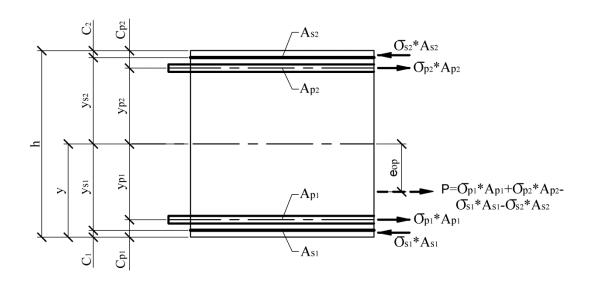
Схема усилий в поперечном сечении преднапряженного железобетонного элемента
